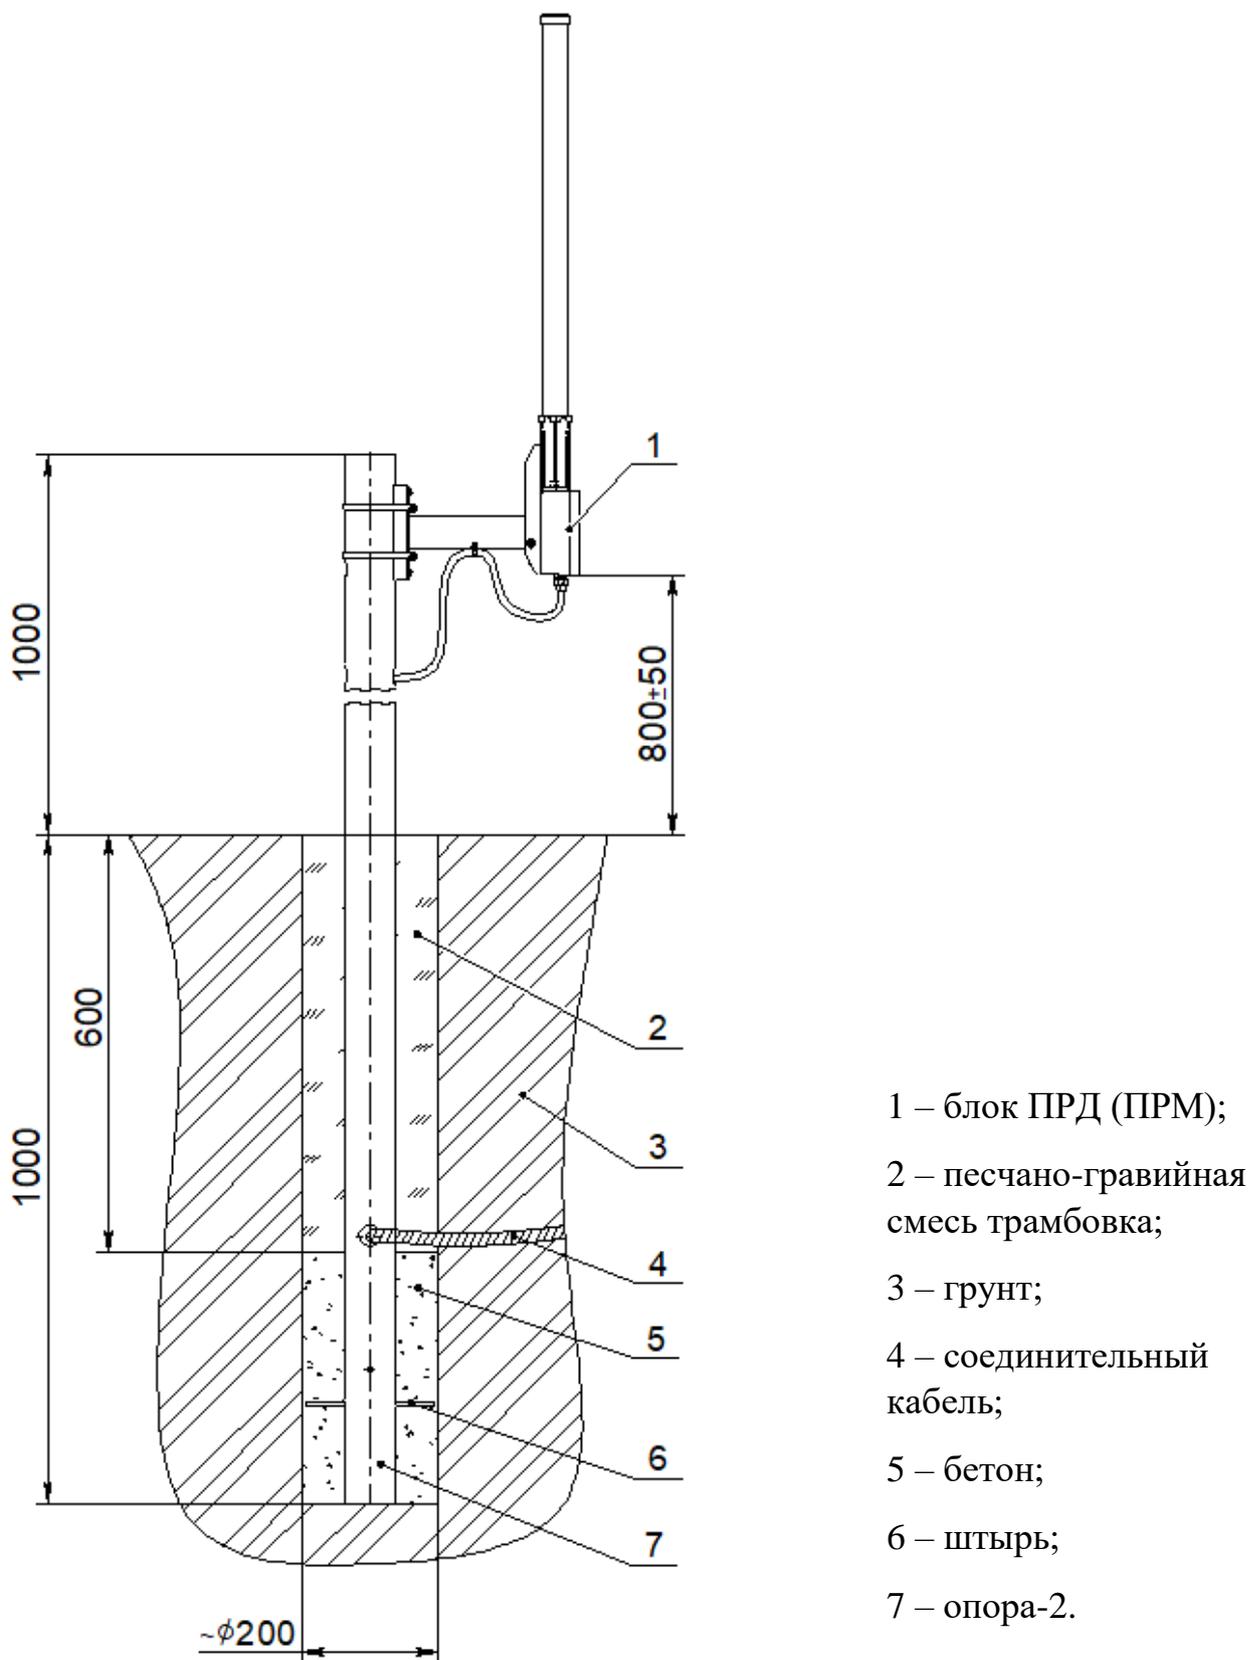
Вариант установки извещателя на круглую опору в грунте.
